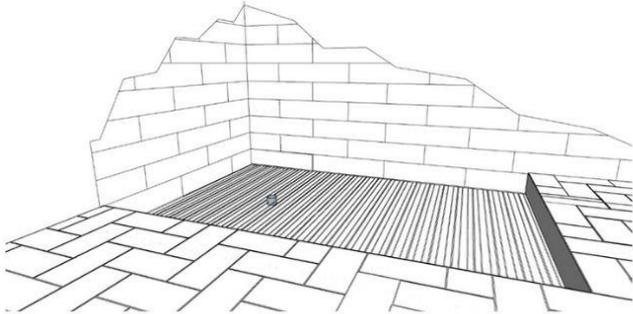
Limpiar e impermeabilizar la zona de instalación
